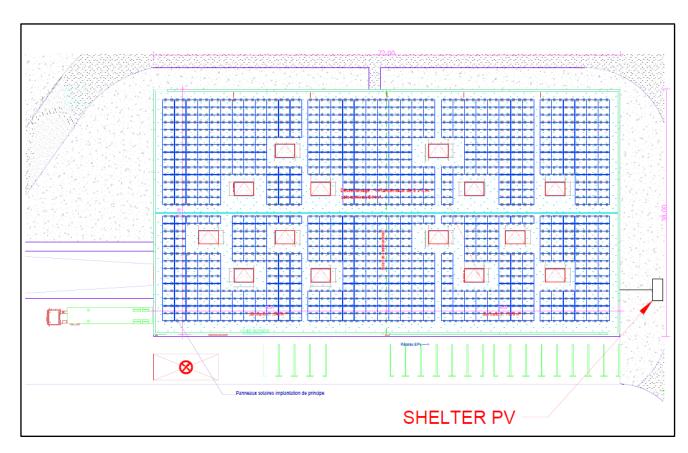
Plan d'implantation des panneaux photovoltaïques
